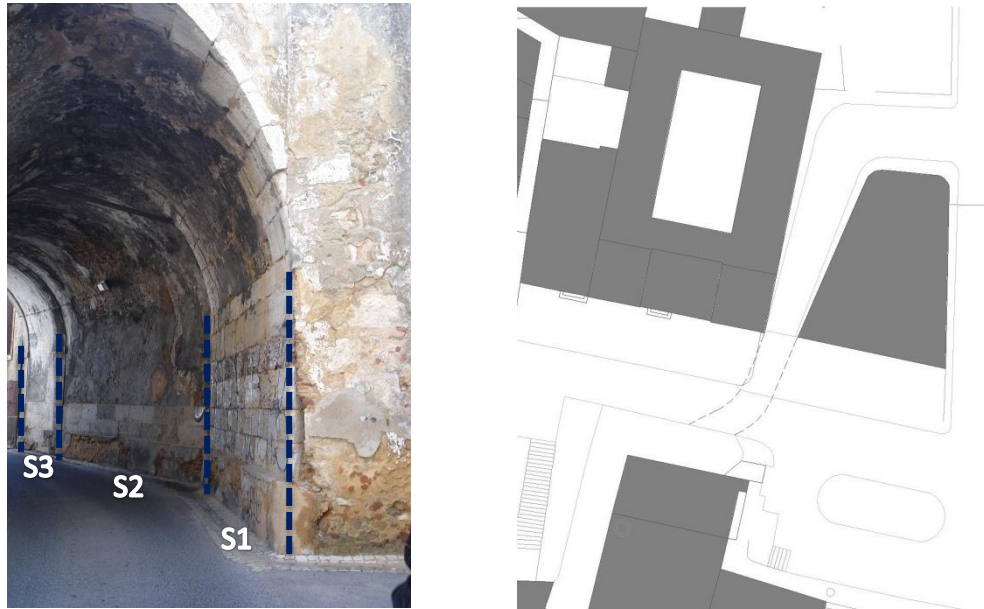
19 - Vista três secções abobadadas que existem debaixo da ponte e planta com representação do túnel (a tracejado)
